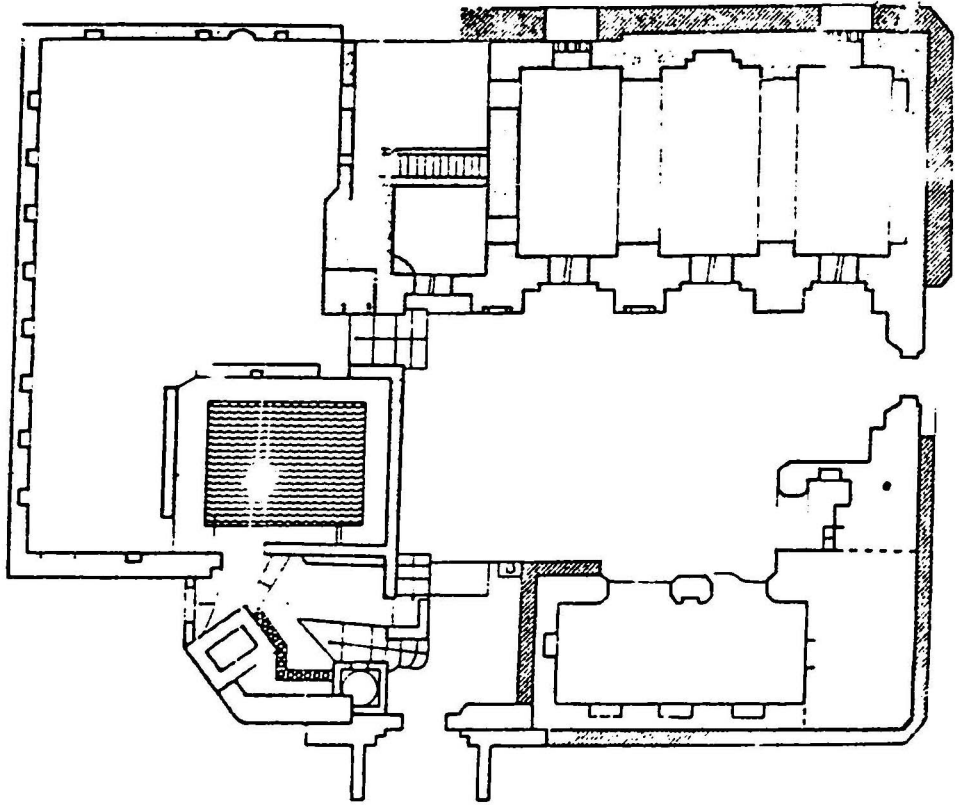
مسقط أفقي للمدرسة السكندرية - زبيد
